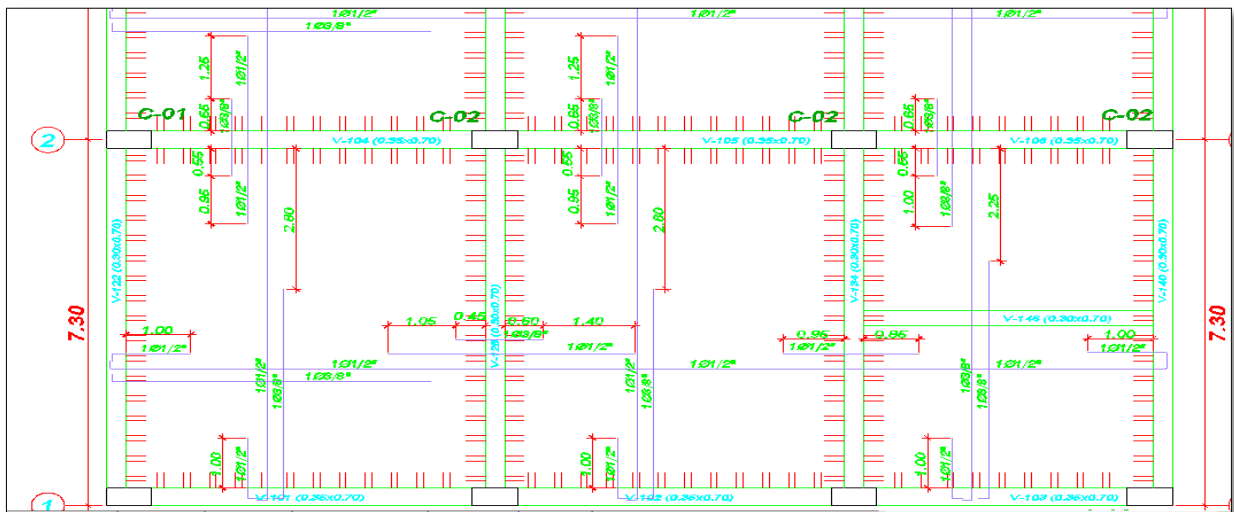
Armadura de losa aligerada en la Dirección Y-Y
